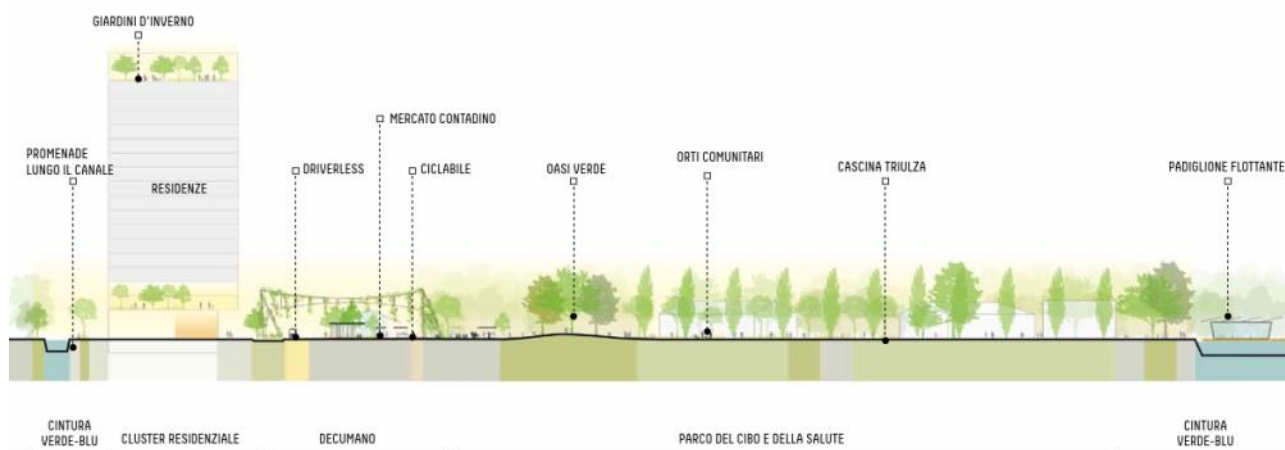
Piazza del Mercato contadino – sezione paesaggistica tipo
